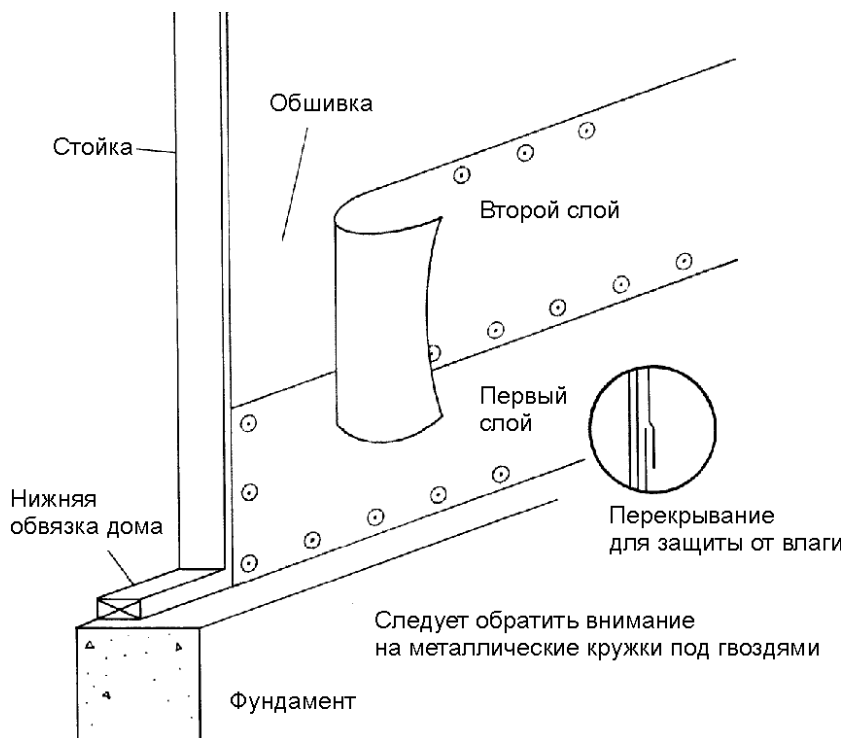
Устройство пароизоляции начинается снизу и выполняется до верха стены. Перекрывание листов организует сток влаги
